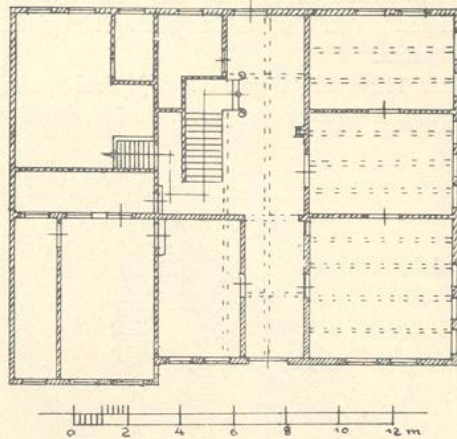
Vorderer Brühl 31. Grundriß. Erdgeschoß.
